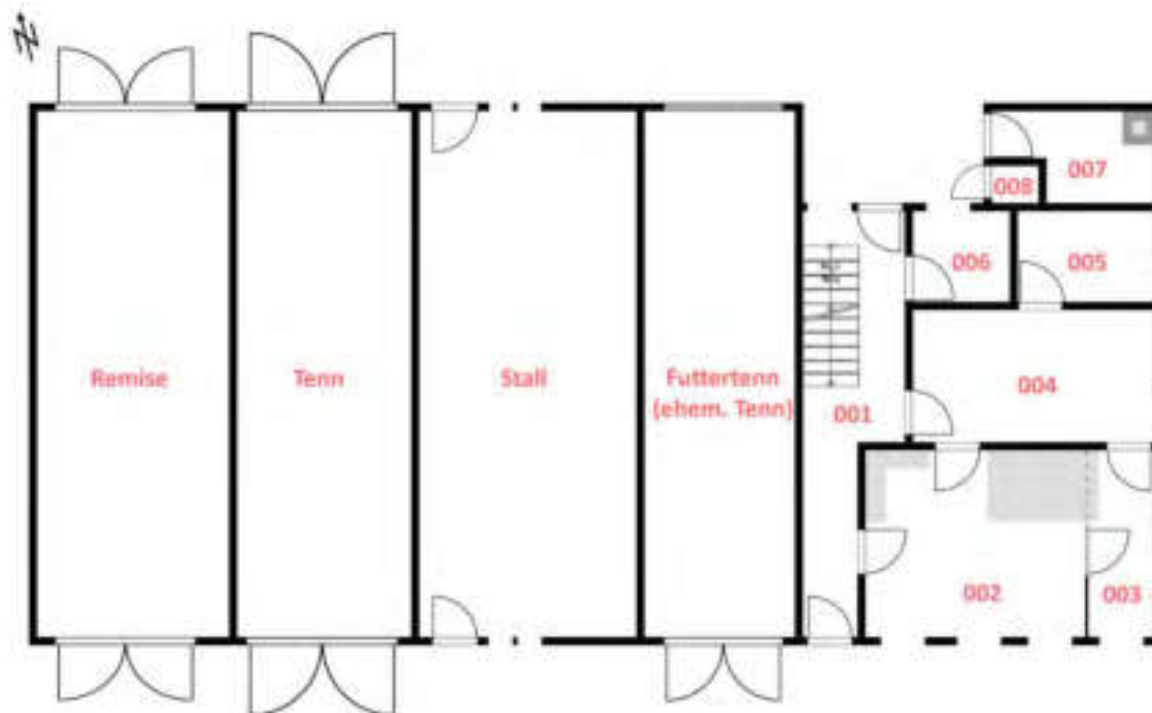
Schematischer Grundriss Erdgeschoss, Bearbeitung IBID.
